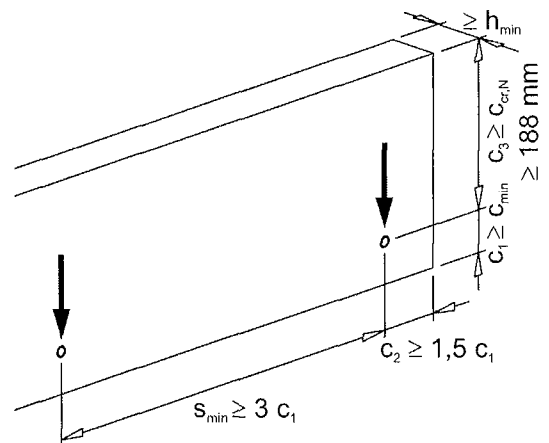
Einbausituation Wandfläche - Querbeanspruchung, ohne Rückhängebewehrung
